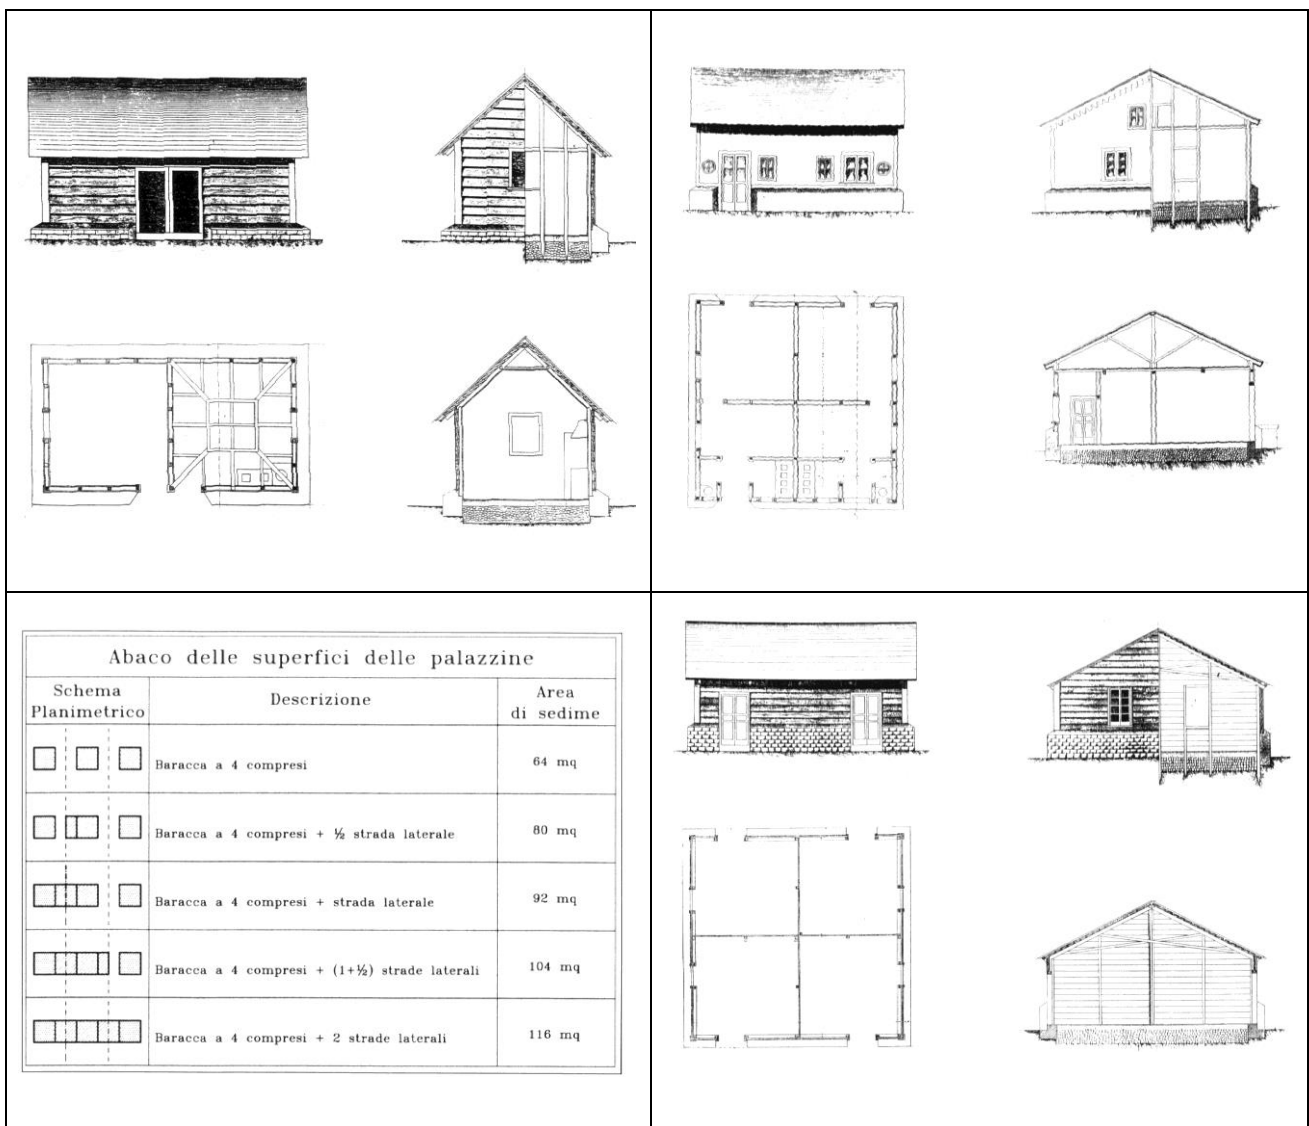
La baracca in pianta, prospetto e sezioni [8]
